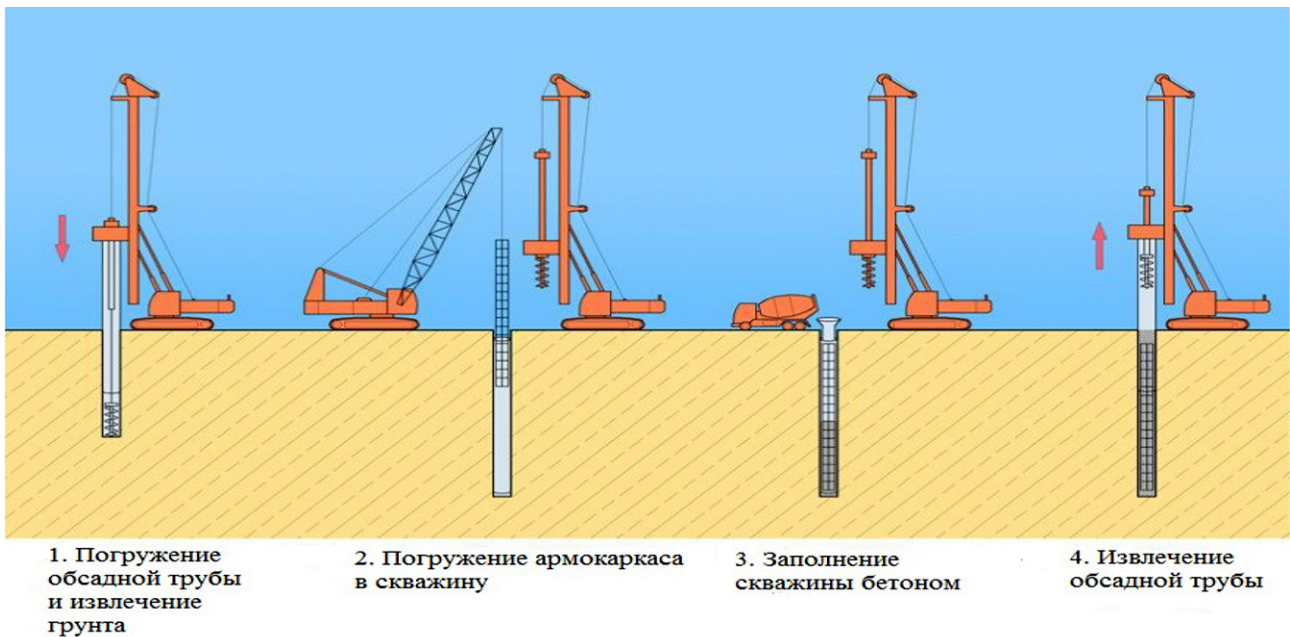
Устройство буронабивных свай с обсадными трубами.
